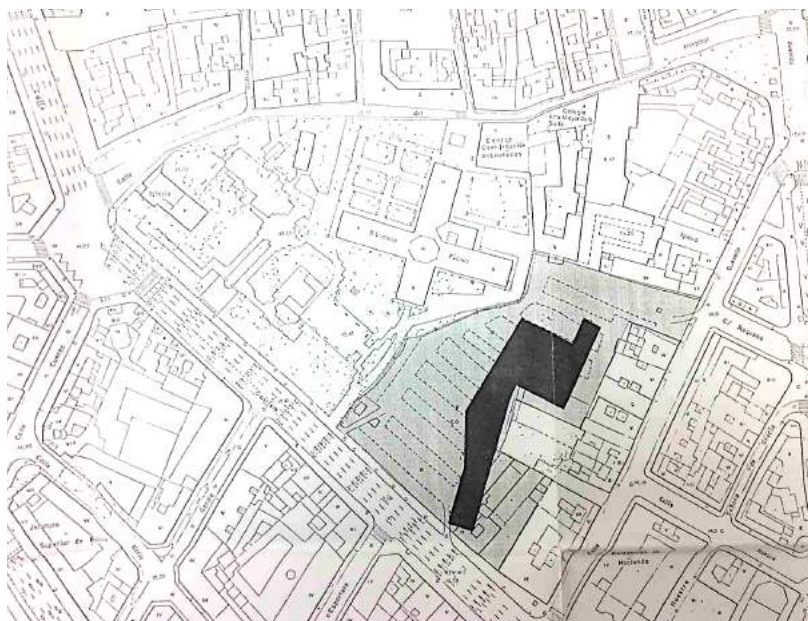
Plano de situación del MuVi en la manzana de la Biblioteca, 1997.
